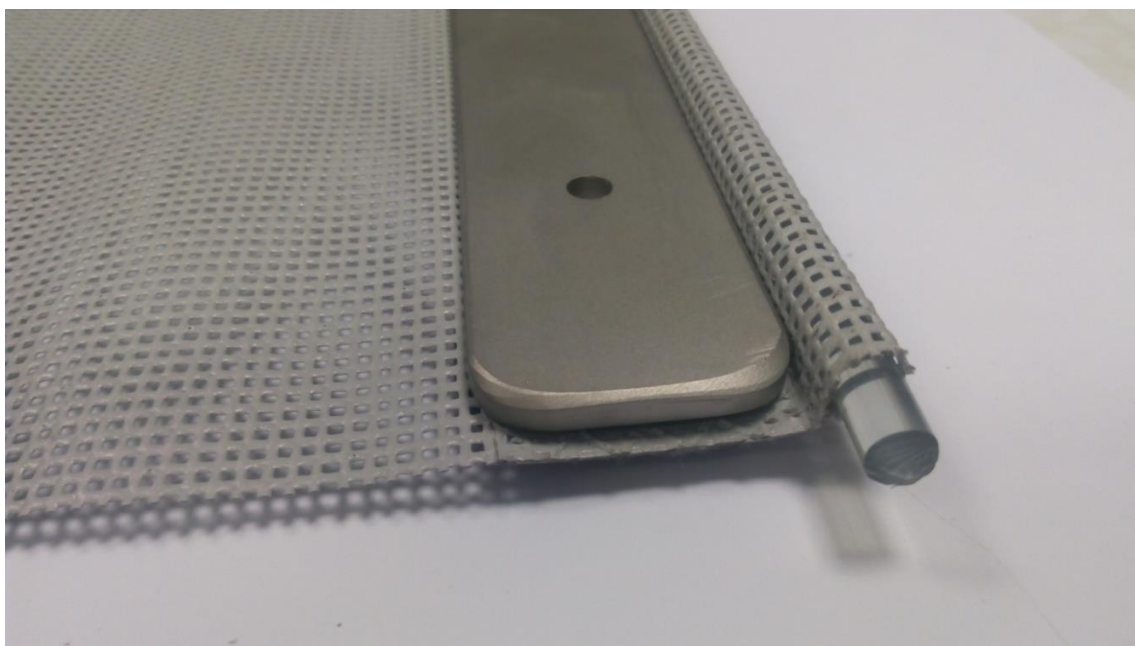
Detail uložení folie ETFE do izolačního kotevního profilu
